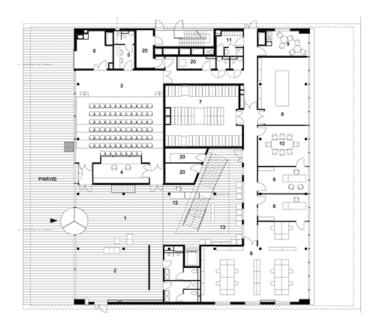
Planta arquitectónica baja, Mediateca Romain Rolland.
